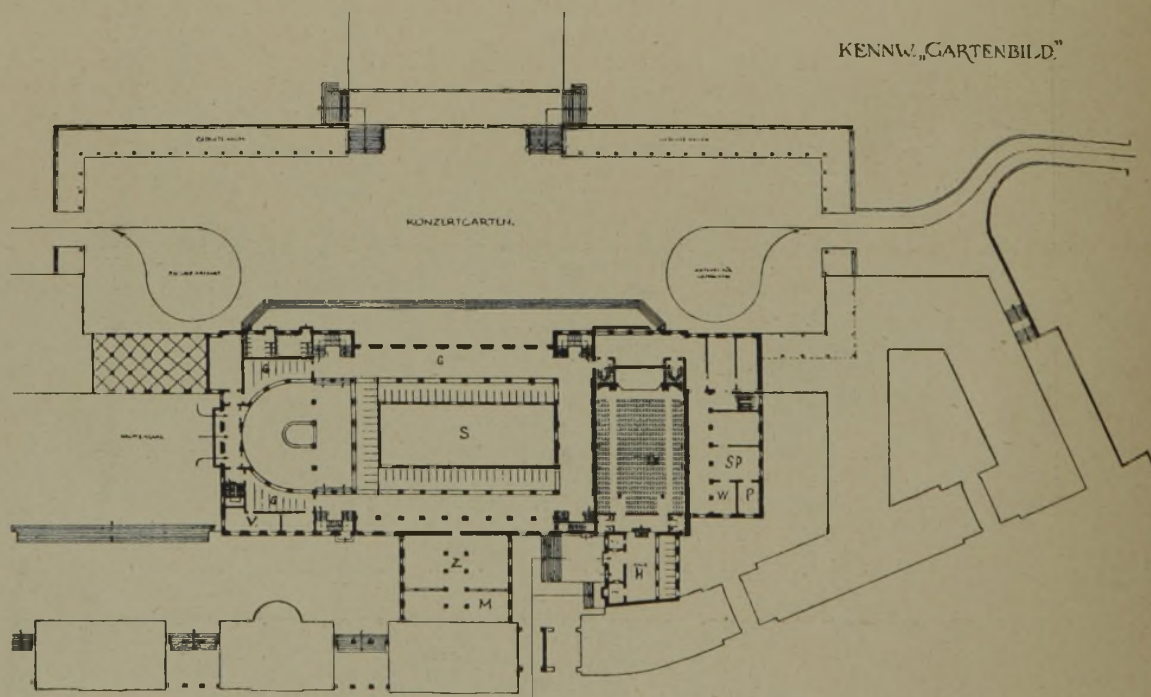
Grundriß vom Erdgeschoß. (Maßstab 1 : 1250.)
